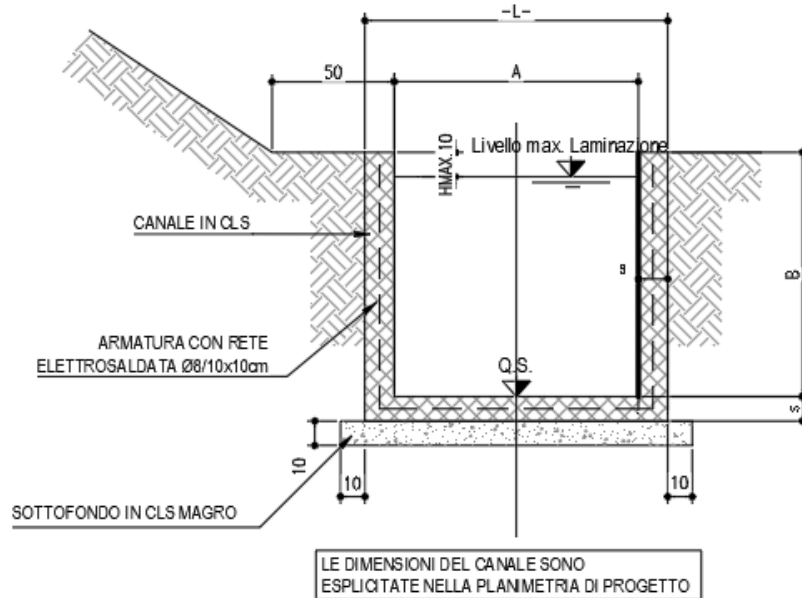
Sezione tipologica dei fossi a sezione rettangolare
